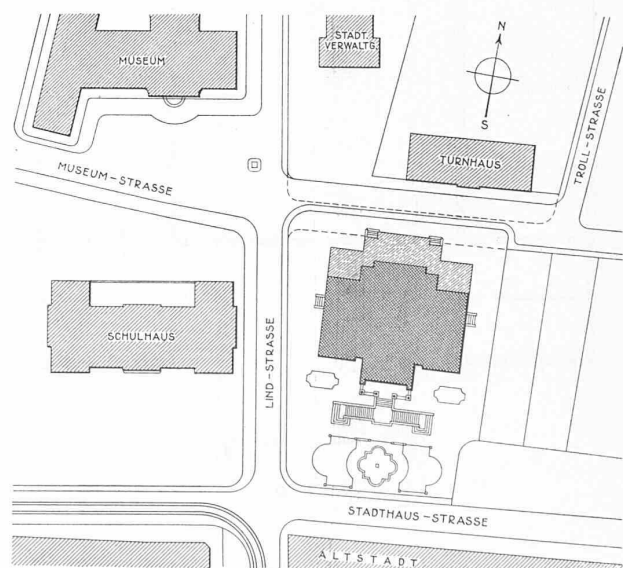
Lageplan des Stadthauses (kreuzweise schraffiert) mit dem geplanten Anbau an der Nordseite. — Masstab 1:2000.
